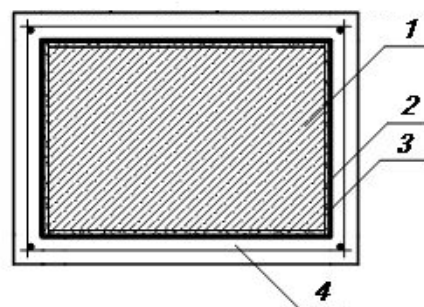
Наружная усиливающая конструкция колонн: 1 – железобетонная колонна, 2 – обмазка из жидкого стекла, 3 – стеклоткань, 4 – железобетонная обойма
